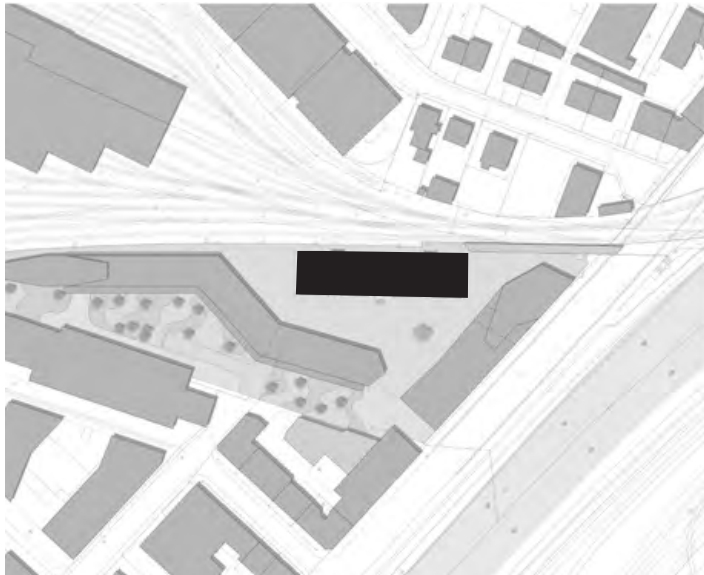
Lageplan, Quelle: burkhalter sumi architekten
